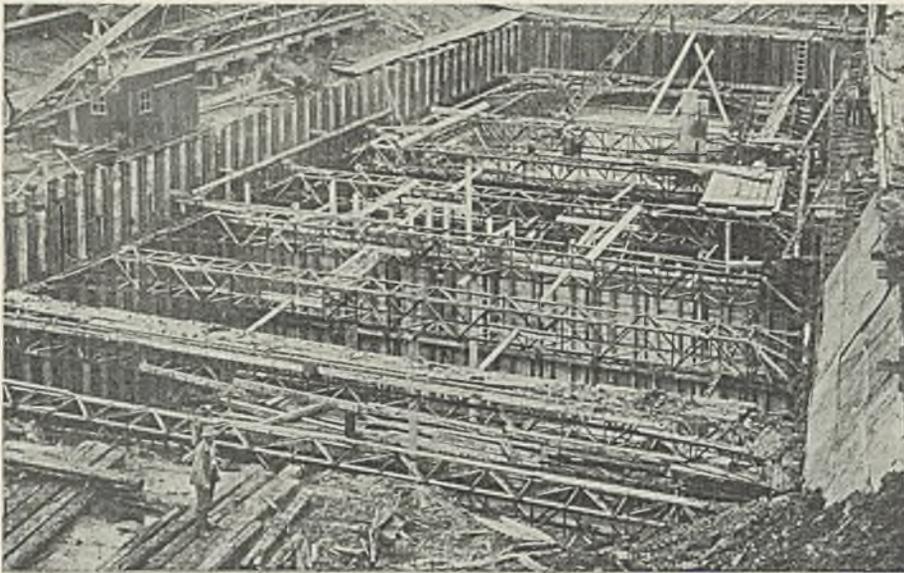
Baugrube der Dockverlängerung, mit eingebauter eiserner Aussteifung.
